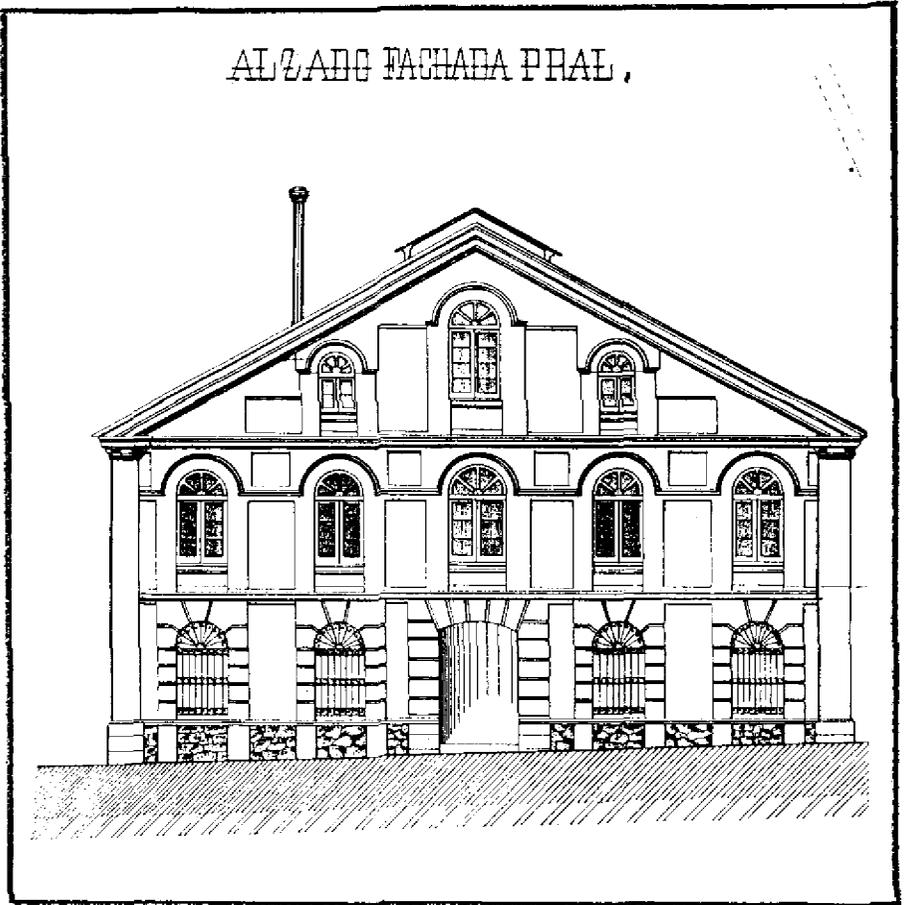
Alzado de la fábrica de cuchillería de los hermanos Garrido, 1889. Arquitecto, Luis Moraleda (A.M.T.)
